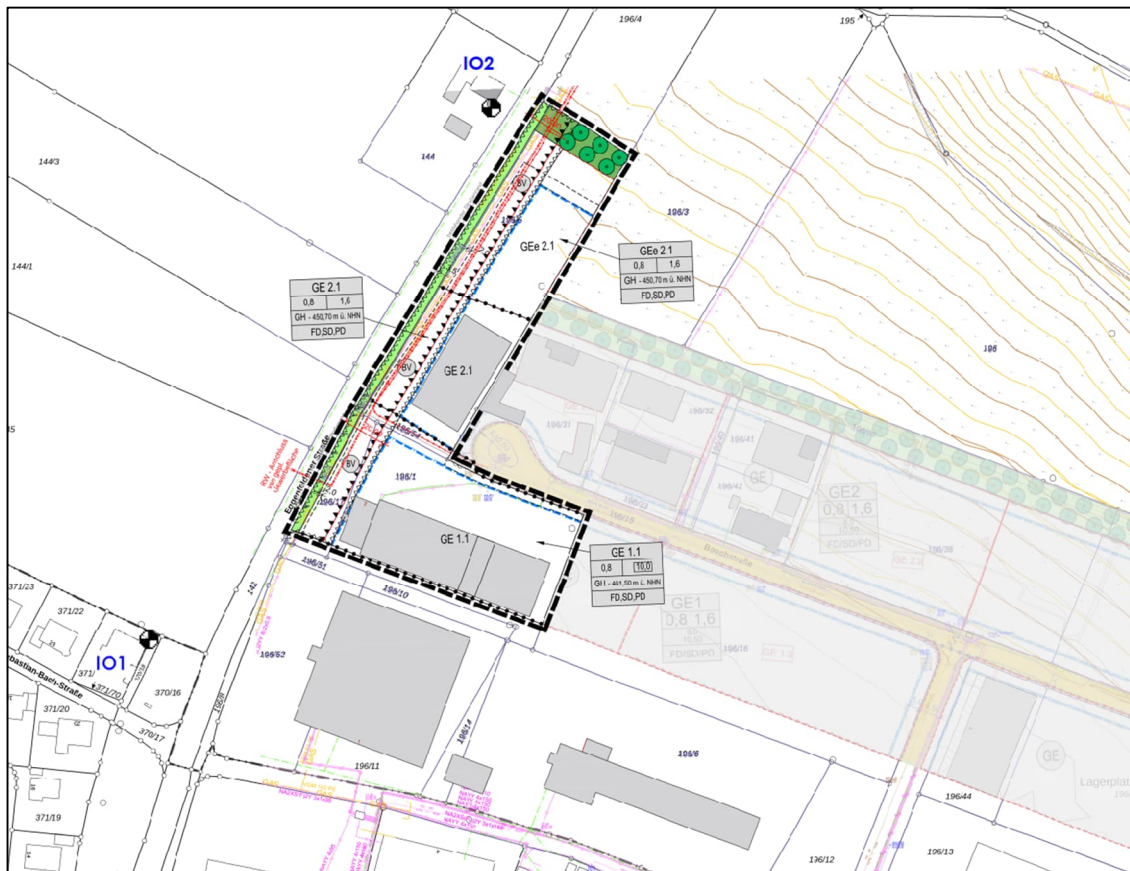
Lageplan /7/ mit Darstellung der maßgeblichen Immissionsorte IO
